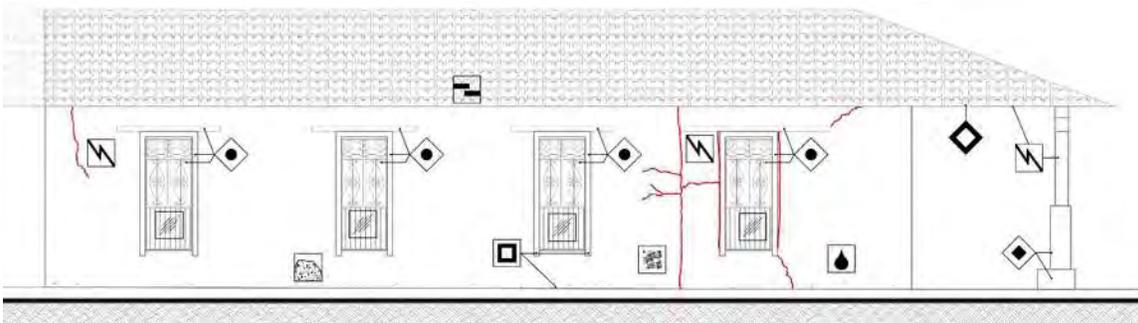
Croquis de fachada norte; se muestra como los principales deterioros la erosión de adobe y el agrietamiento vertical del muro. Elaboró: AMT.
